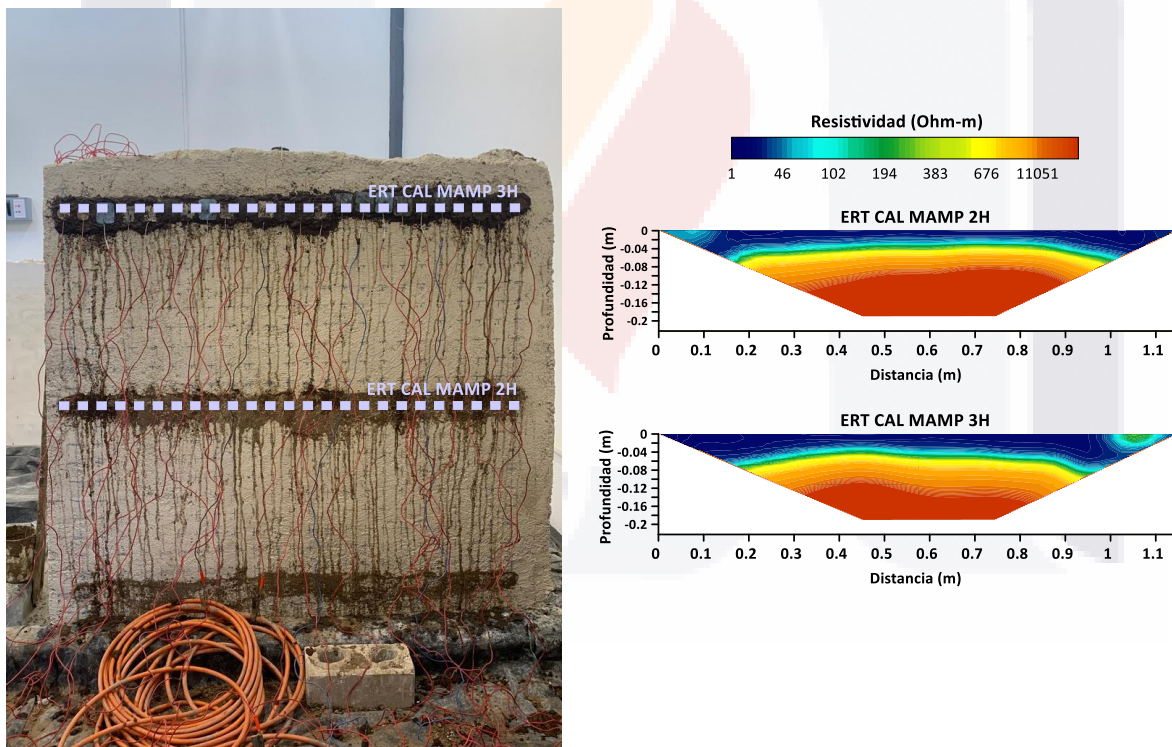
Prueba de calibración de ERT en muro de mampostería de piedra. Procesamiento en ProsysII, Zondres2D, Surfer 16. Elaboración propia.
